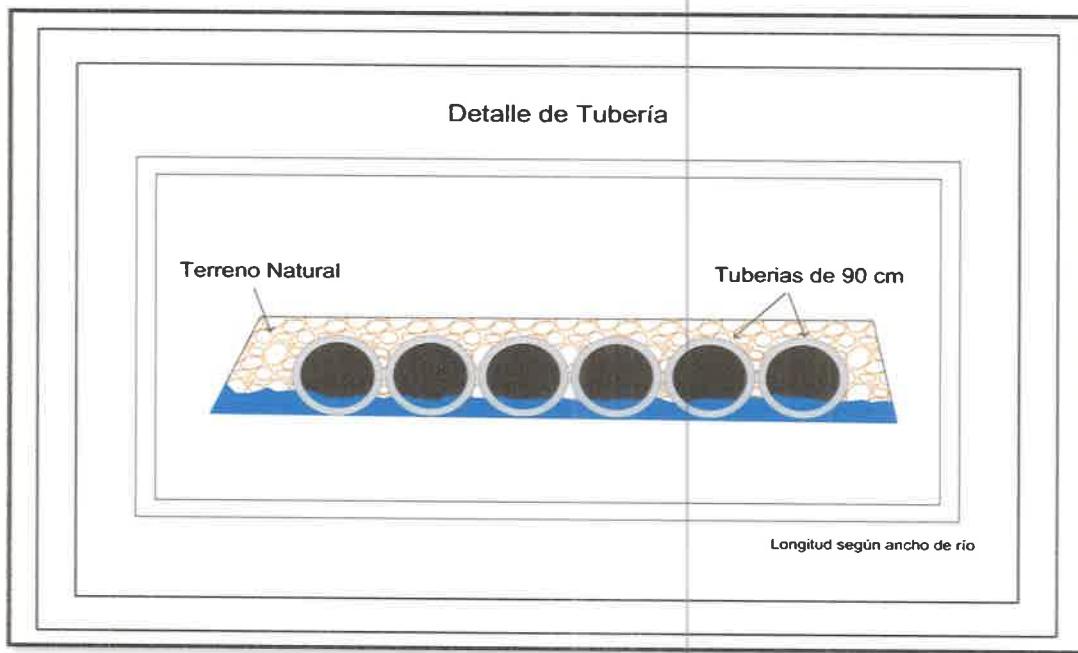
Detalle de tubos de hormigón para cruce o camellón.
